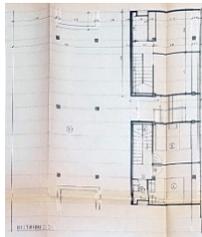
Planta baja dúplex Instalaciones B-2-4. 1964. Fuente: Archivo Municipal da Coruña
